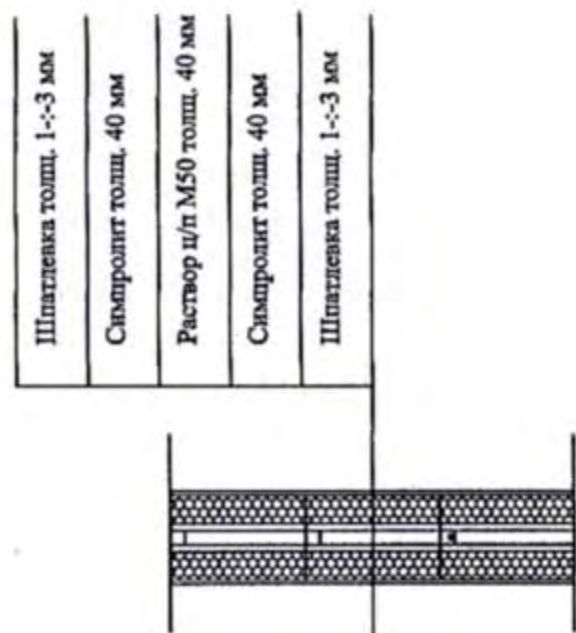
Испытуемая конструкция перекрытия с применением Симпролита
